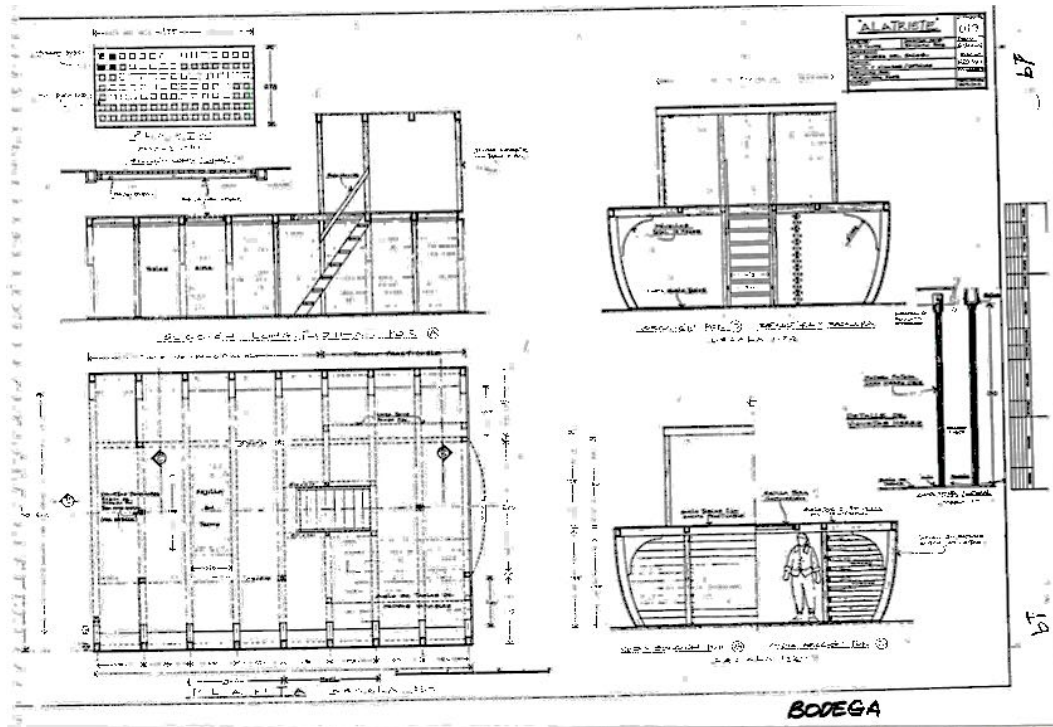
Plano. Bodega del galeón. Planta y alzados. *Alatrisme*.
